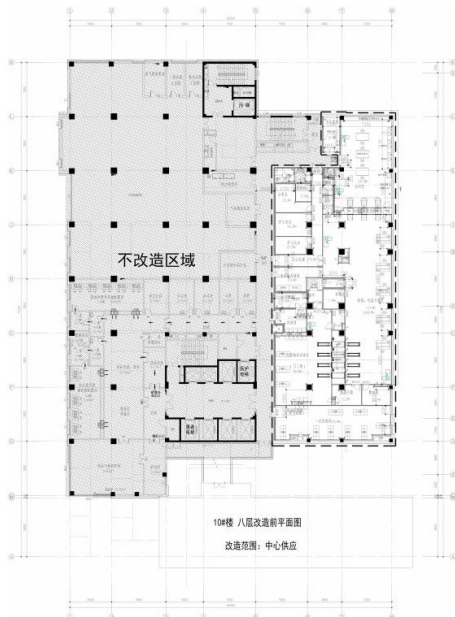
10 号楼 8 层改造前平面图 图 5-18 10 号楼 8 层改造后平面图
